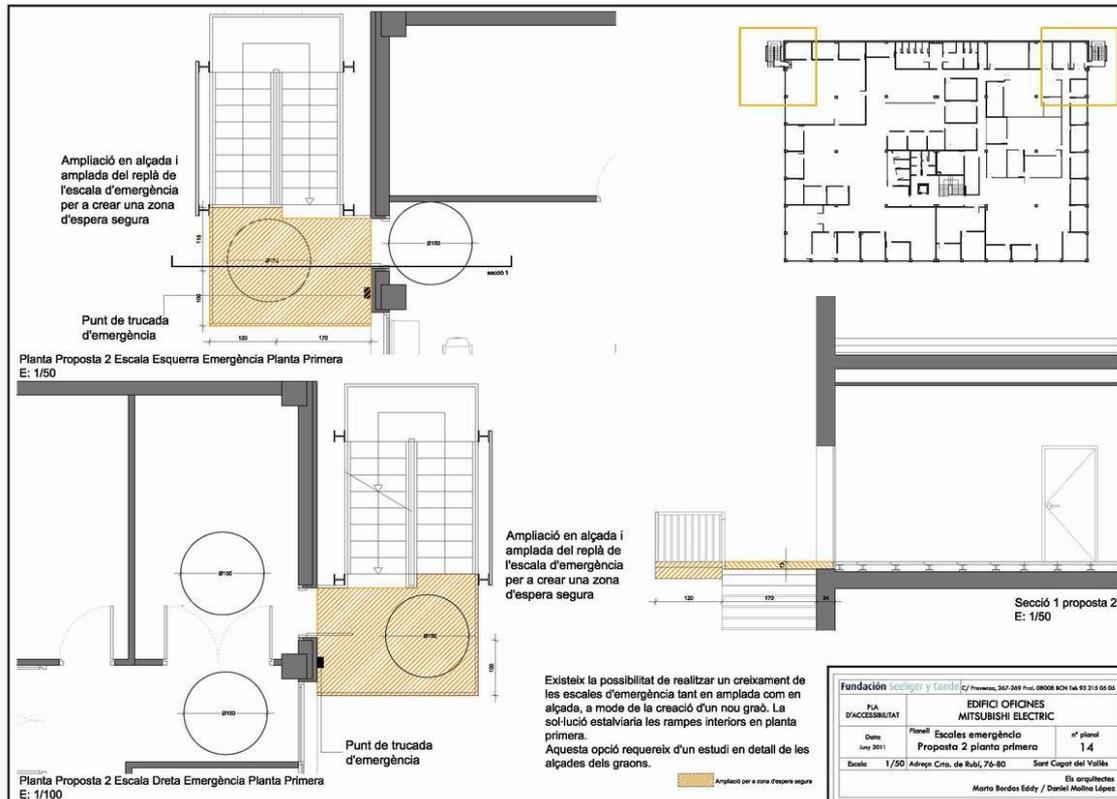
Edificio Oficinas MITSUBISHI ELECTRIC. Propuesta nuevas escaleras de emergencia Planta Primera.
